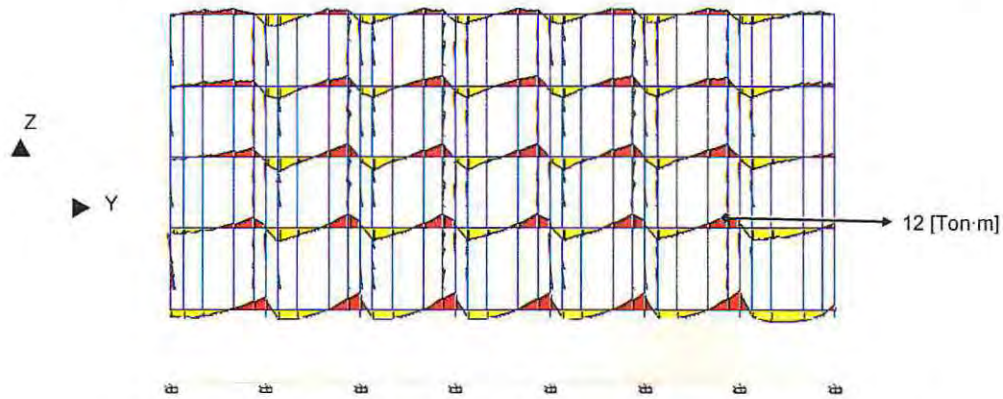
Diagrama de momento en vigas de fachada, eje A, estructura aislada.
